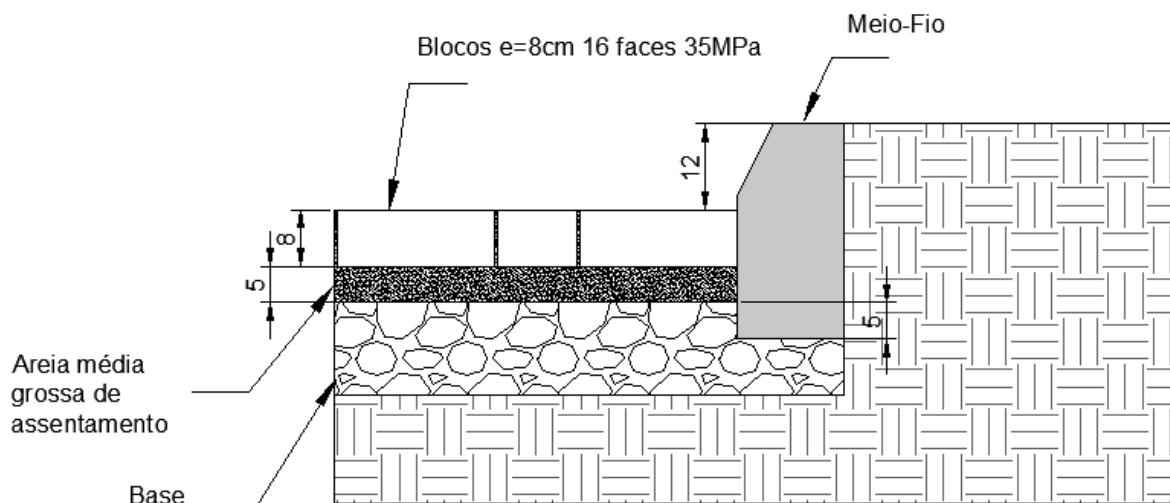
Esquemático do assentamento de meio-fio paralelo à pista de rolamento.
